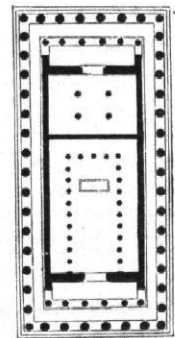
| Grundriß des Parthenon zu Athen | 1 : 2000
